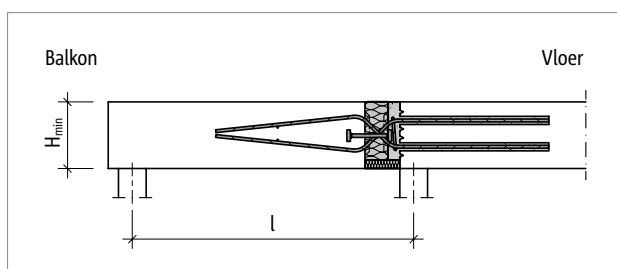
Schöck Isokorb® RT type Q-P: Statisch systeem
